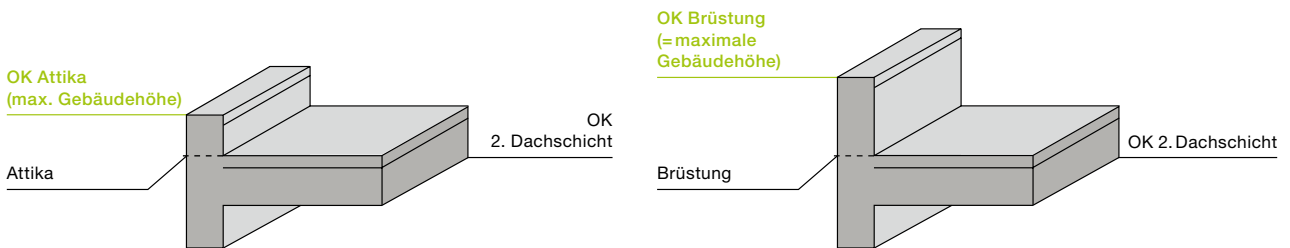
Bezugspunkt für Gebäudehöhe bei Flachdächern ohne und mit Dachterrasse
